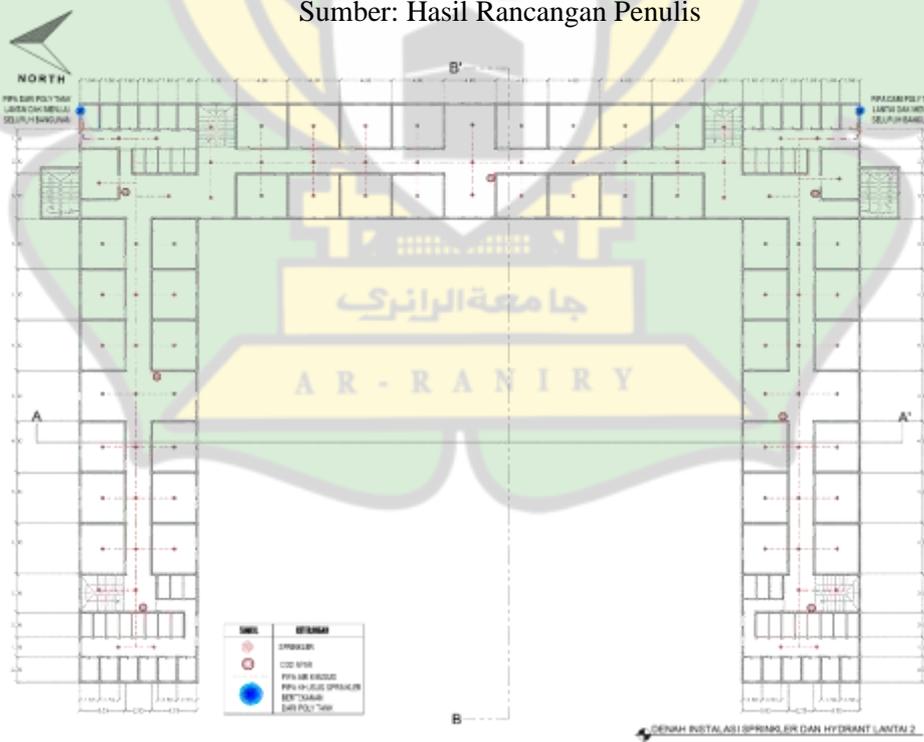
53 Skema Instalasi Plumbing Asrama
